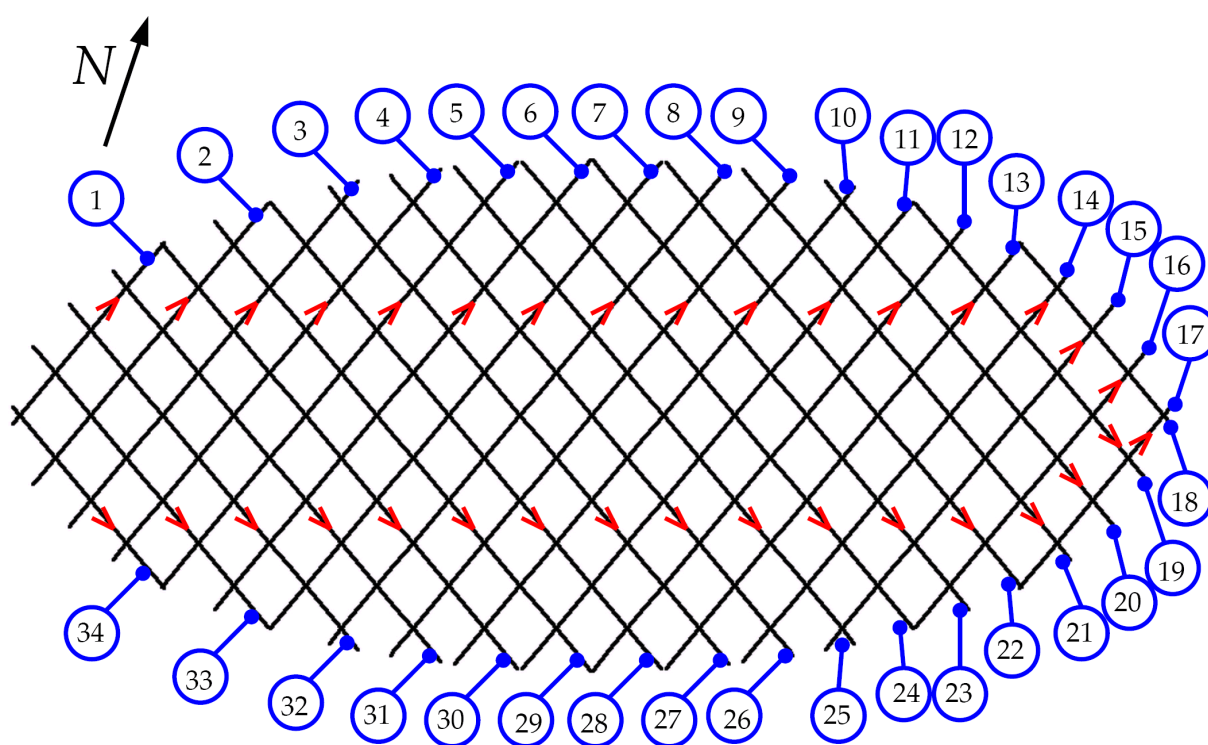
Plan de la grille à plat avec l'orientation des barres.
